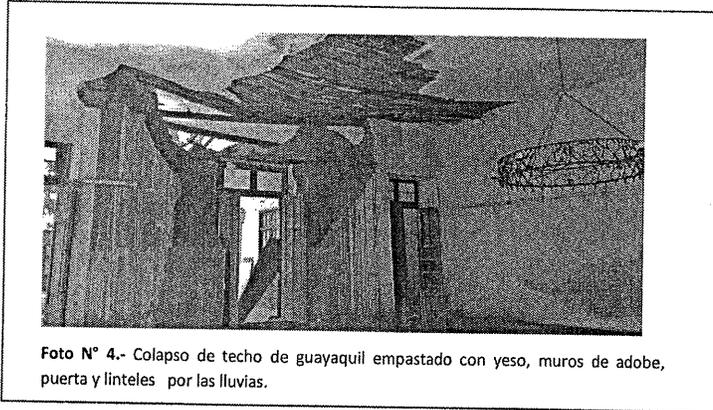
Colapso de techo de guayaquil empastado con yeso, muros de adobe, puerta y linteles por las lluvias.
